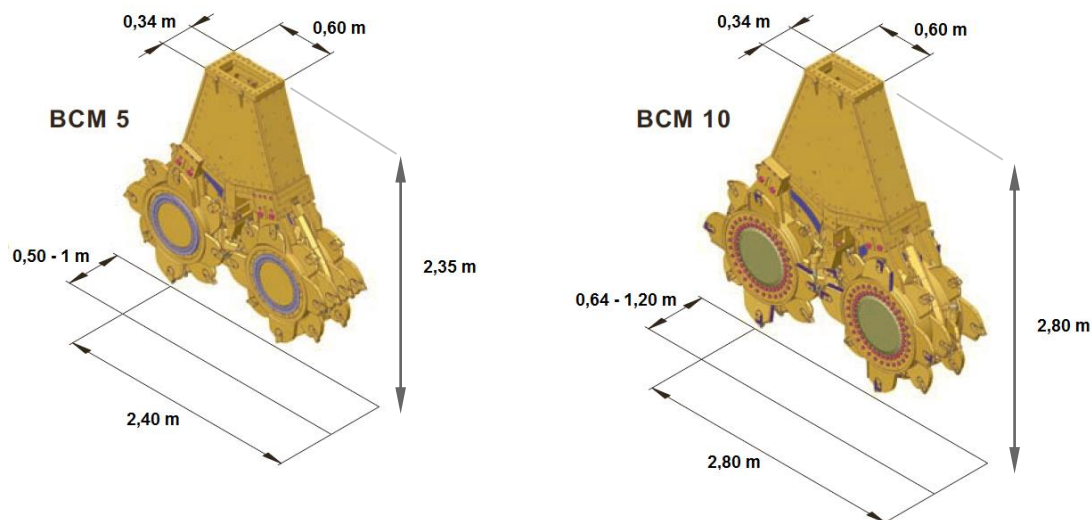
Ferramentas de corte (adaptado de Bauer, 2010).
